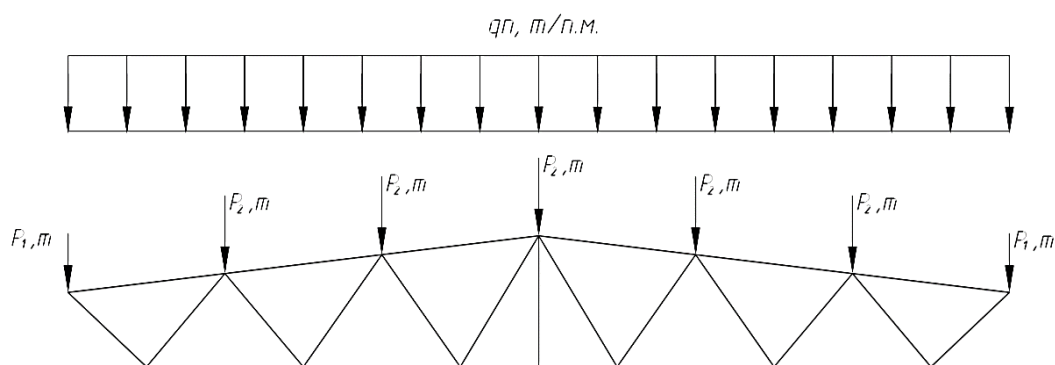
Схема приложения нагрузки от веса покрытия
